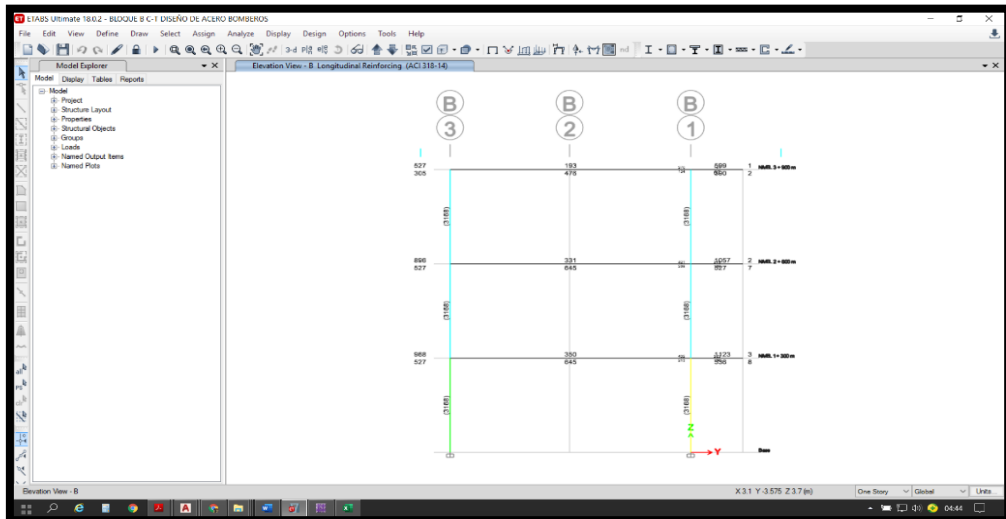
Bloque A - Acero longitudinal en el eje elevación eje B-B
